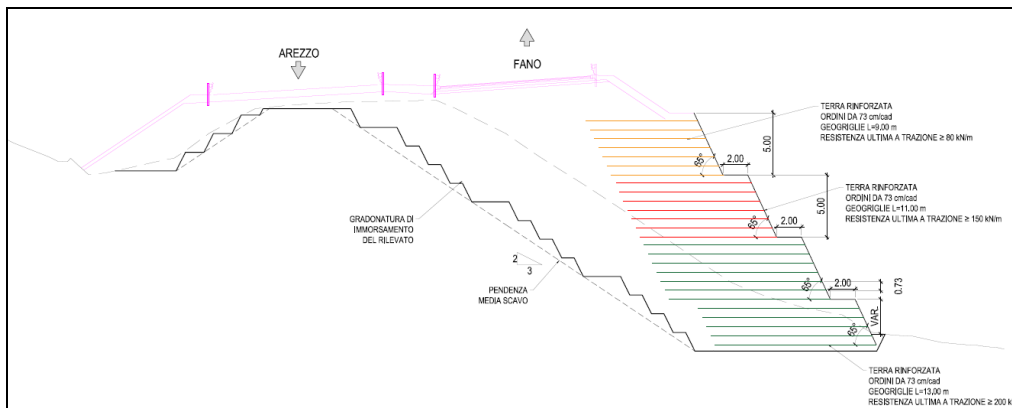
Sezione schematica del rilevato in terra rinforzata dalla pk 1+980 alla pk 2+110
